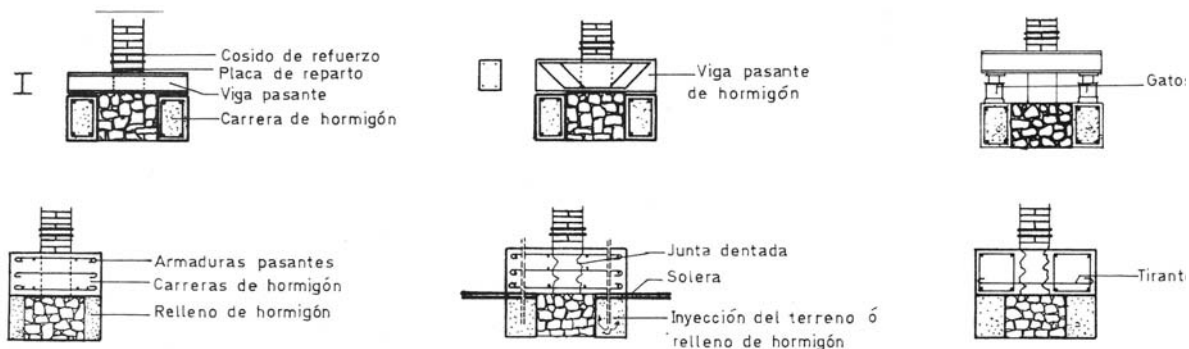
Soluciones de puenteo y ensanche de zapatas corridas
